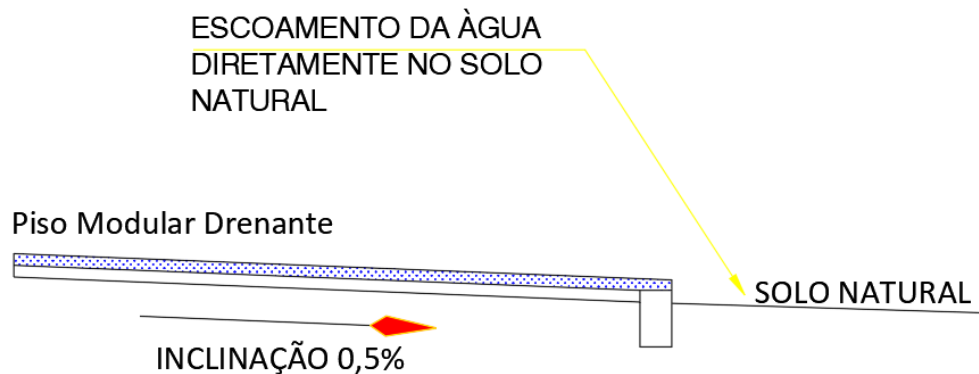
Detalhe inclinação (Fonte: Autor/2024)
